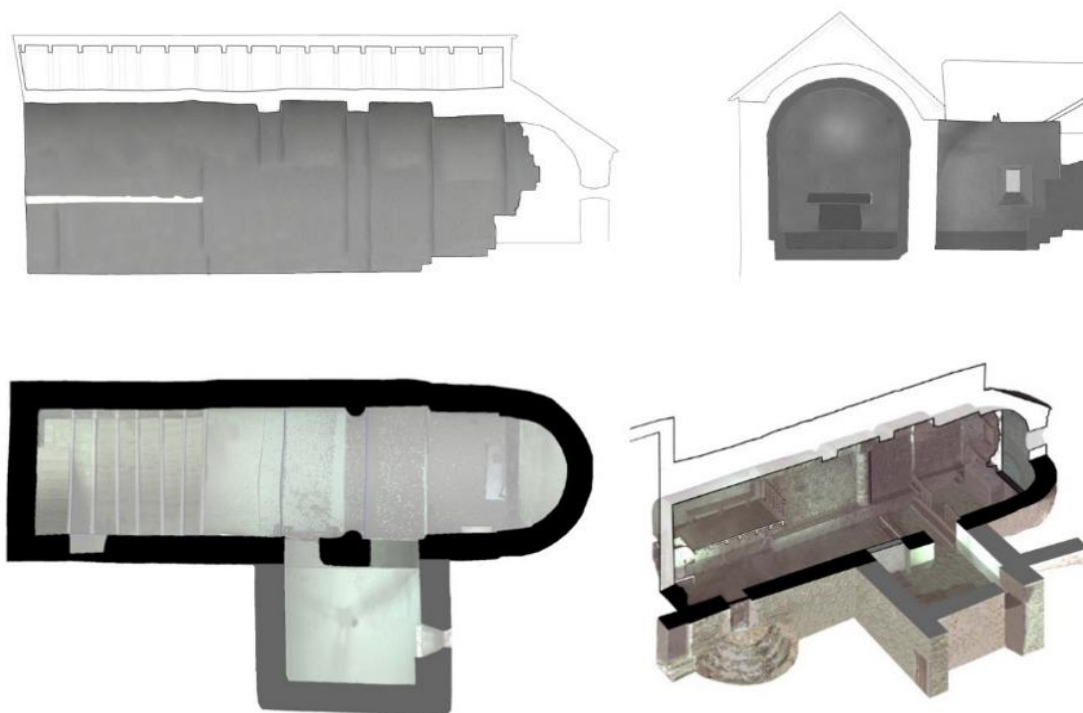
Planimetría de la iglesia de Sant Joan d'Arros e Vila. e.:1/200
